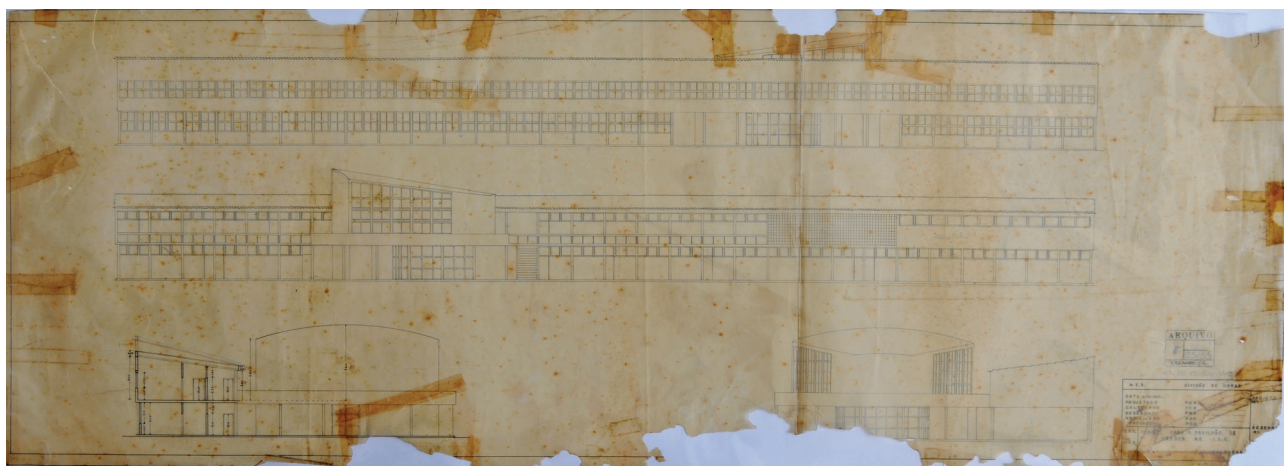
| Desenho com fachadas e cortes, de autoria de Jorge Ferreira.
